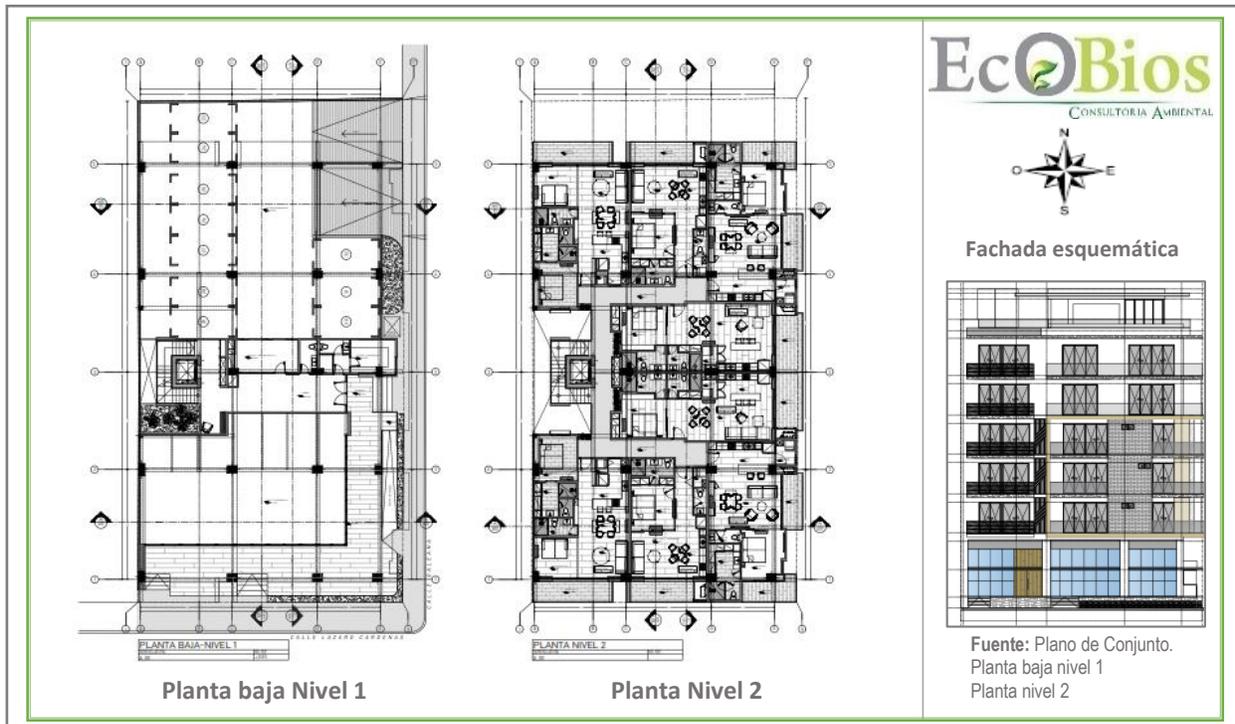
Detalle del diagrama del polígono planta baja nivel 1 y planta nivel 2
